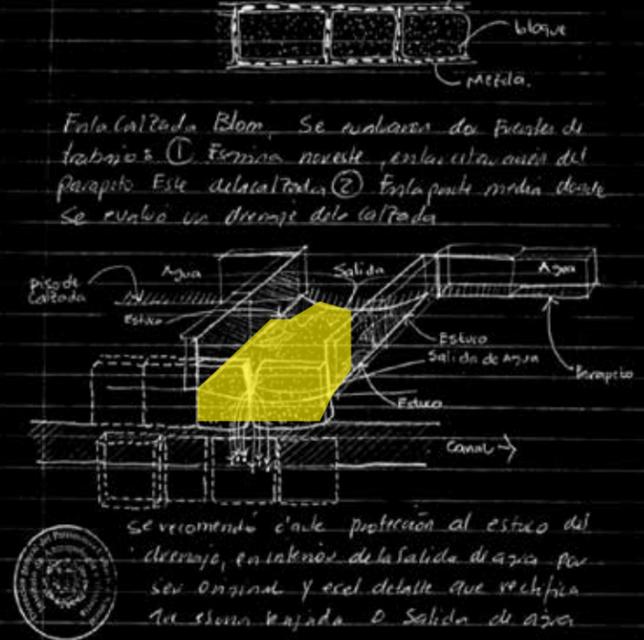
Dibujo Calzada Blom, Parte media de la calzada. Detalle técnico constructivo del drenaje del parapeto este. Dibujo: GAMH 2002
